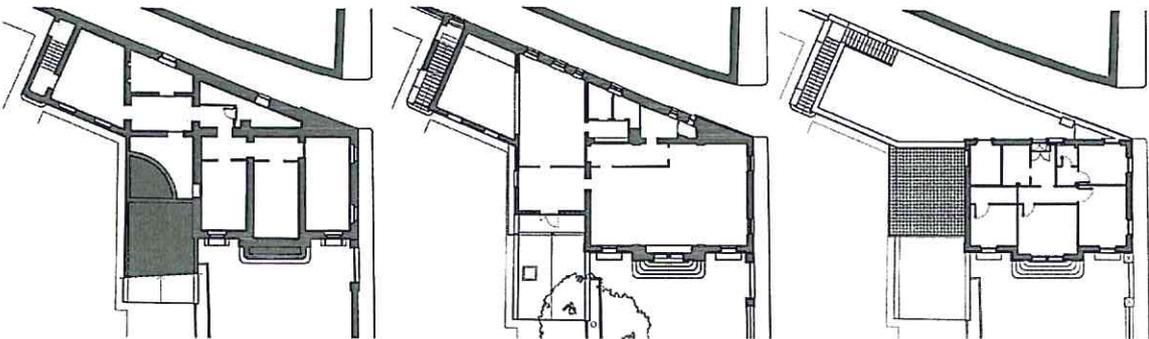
, piante dello stato attuale, da sinistra: piano seminterrato, piano rialzato e piano primo.
